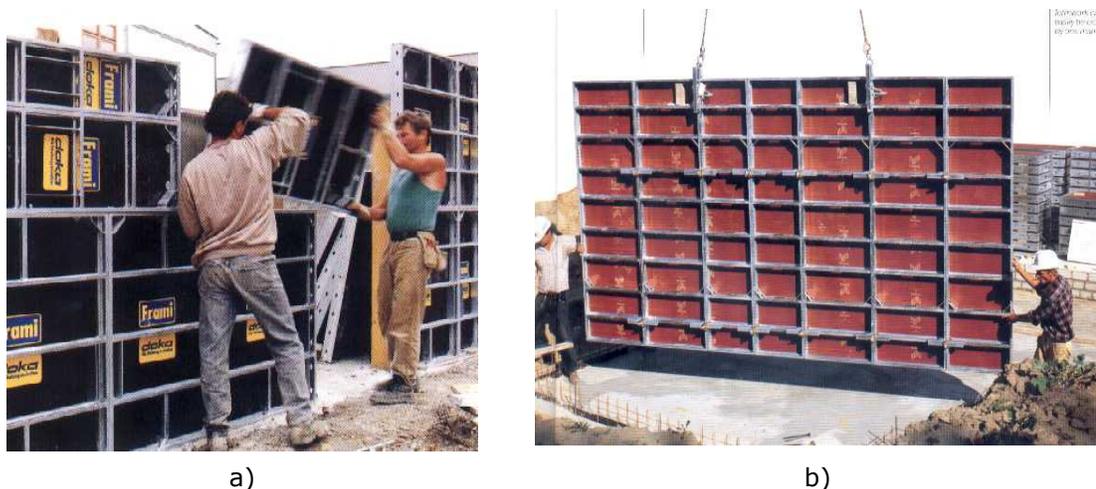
Sistema modular: a) montagem de fôrma de parede com painéis metálicos (Doka, s.d.); b) movimentação de painel de fôrma composto por painéis metálicos modulares associados (SH, s.d.).
